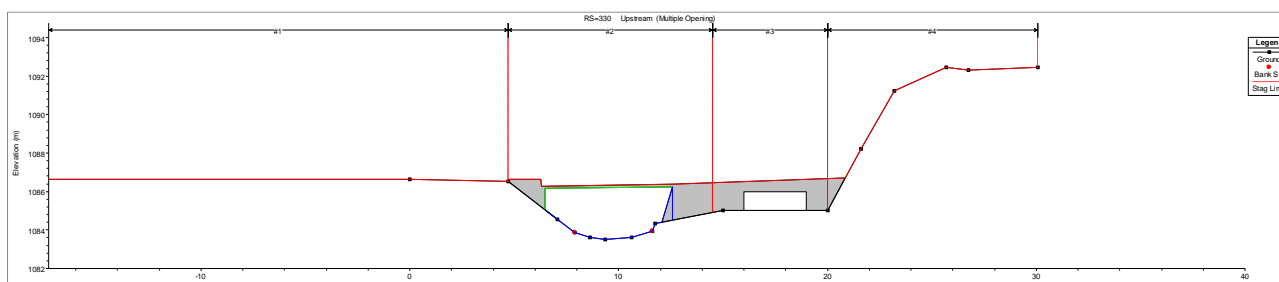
Profil en travers projet au droit du pont route des Lanches
